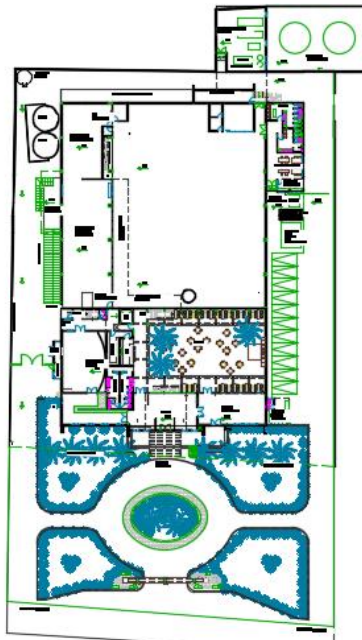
Distribución de áreas planta baja fábrica de cerveza.
